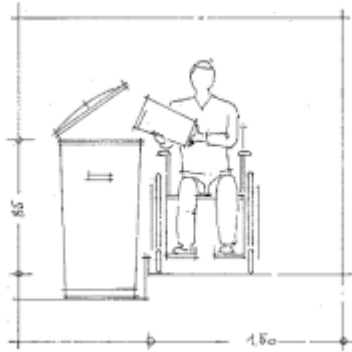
Müllgefäß Bewegungsfläche – und höhe
